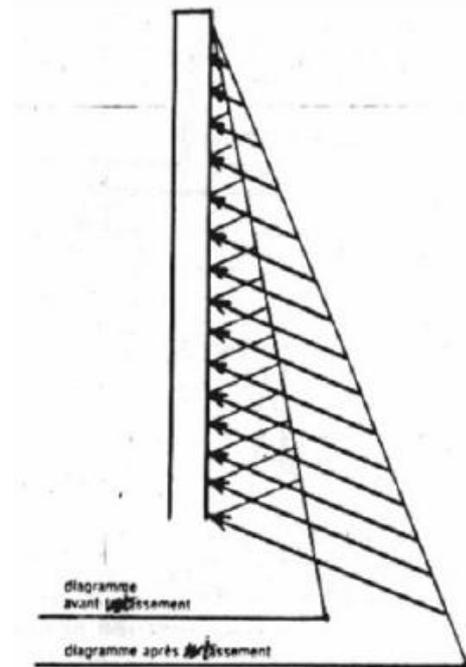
Effet sur les poussées d'un déversement du mur.
